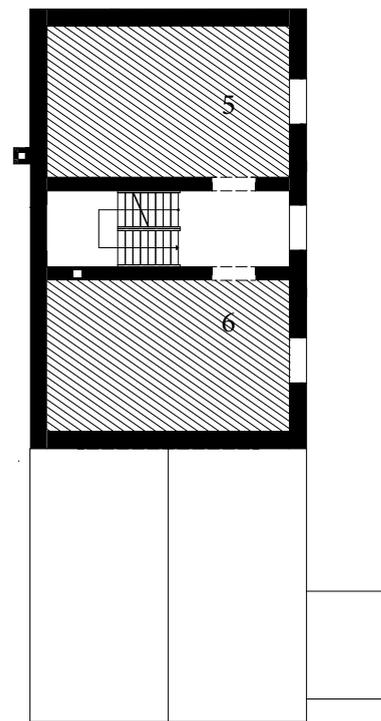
Grundriss Obergeschoss 2. Bauphase 1:200
